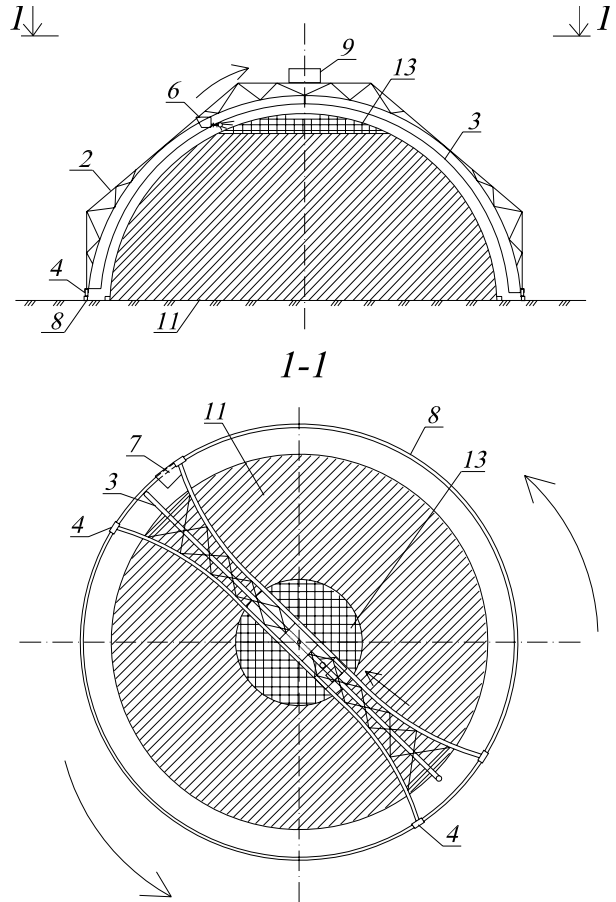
Армирование потолочной части купола: 1 – опалубка купола; 2 – несущая арка; 3 – направляющая; 4 – ролики; 5 – арматурная бухта; 6 – торкрет-установка; 7 – механизм вращения несущей арки; 8 – роликовые пути; 9 – механизм подъема; 10 – навитая арматура; 11 – бетон оболочки купола; 12 – упоры; 13 – арматурная сетка.
